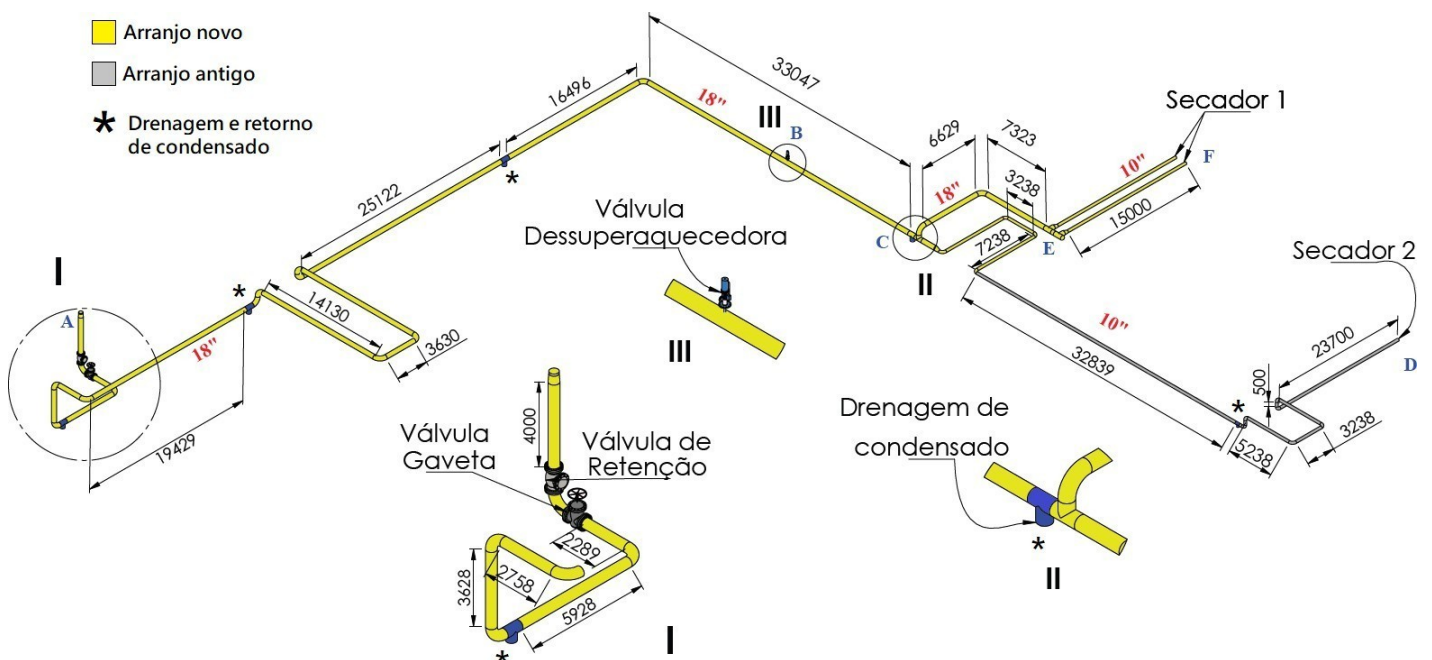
Layout atual da rede de vapor proposta (dimensões em mm).
